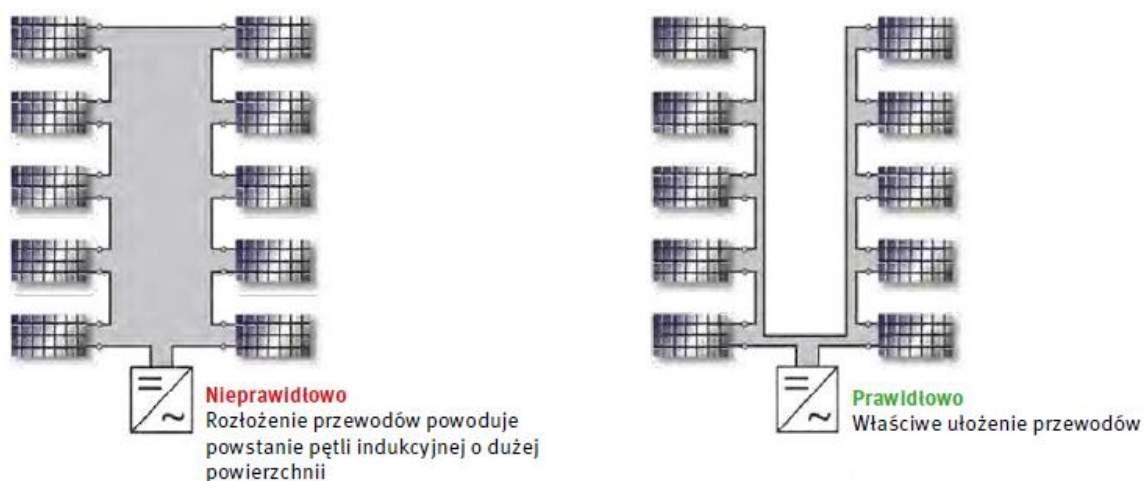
Przykładowa wizualizacja montażu modułów fotowoltaicznych i falownika.
